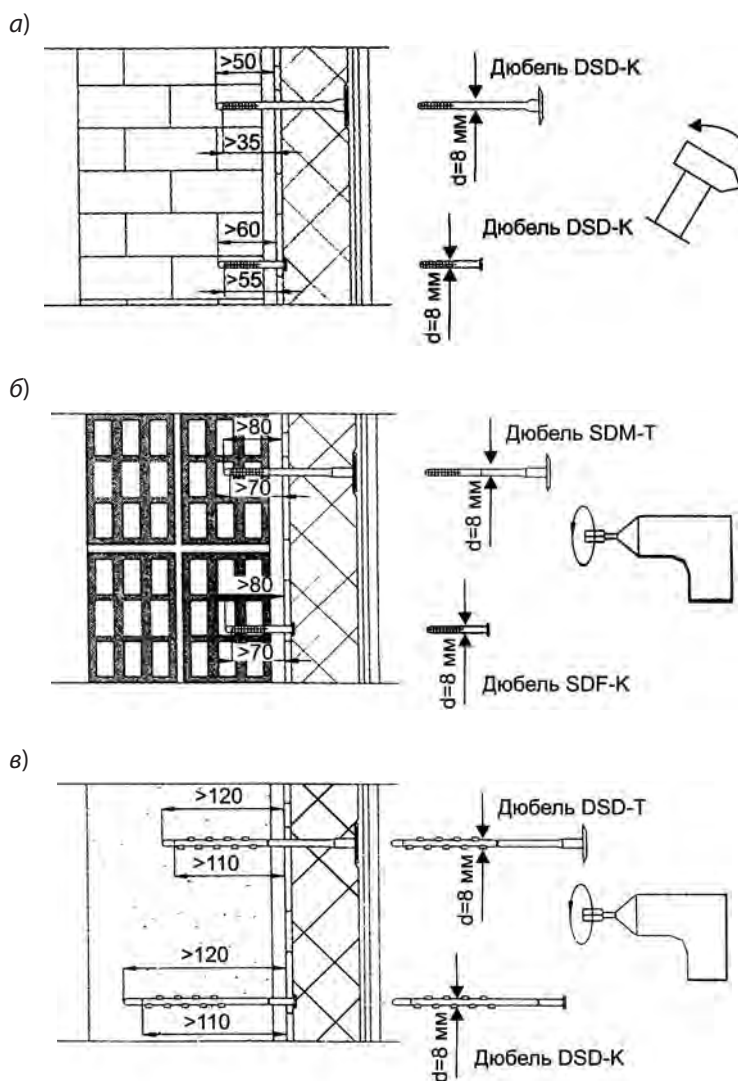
Крепление дюбелями плит FACADE BATTS и FACADE SLAB:
